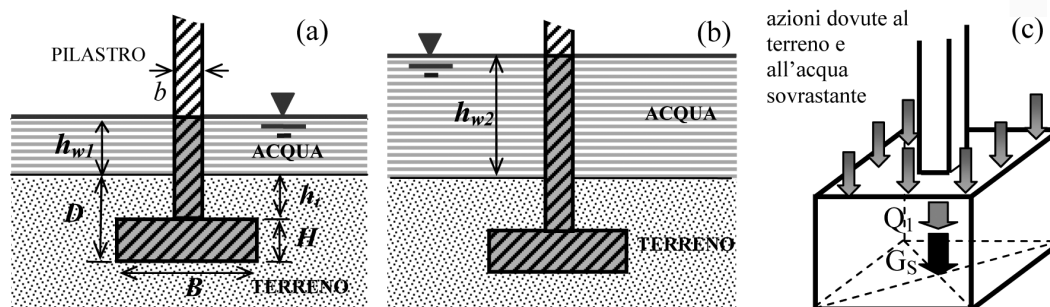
Schema delle due fondazioni analizzate: a) fondazione 1; b) fondazione 2; c) assonometria.
